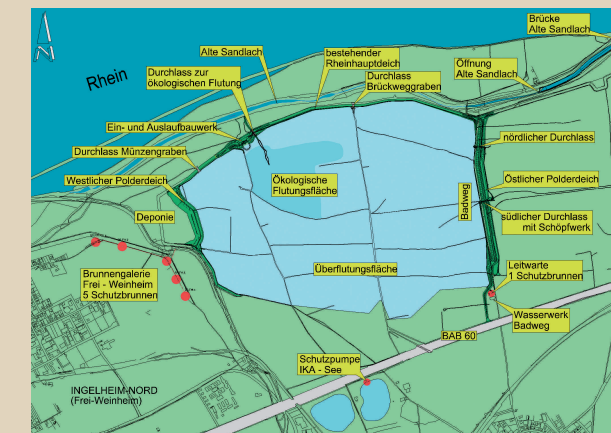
Lageplan mit den Komponenten des Polders Ingelheim
